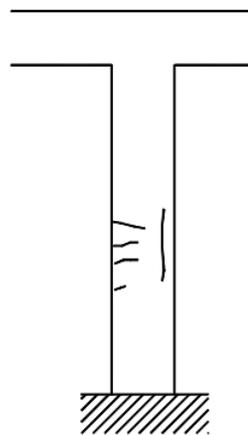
Fisuración por pandeo en columnas (Pérez, 1994).
